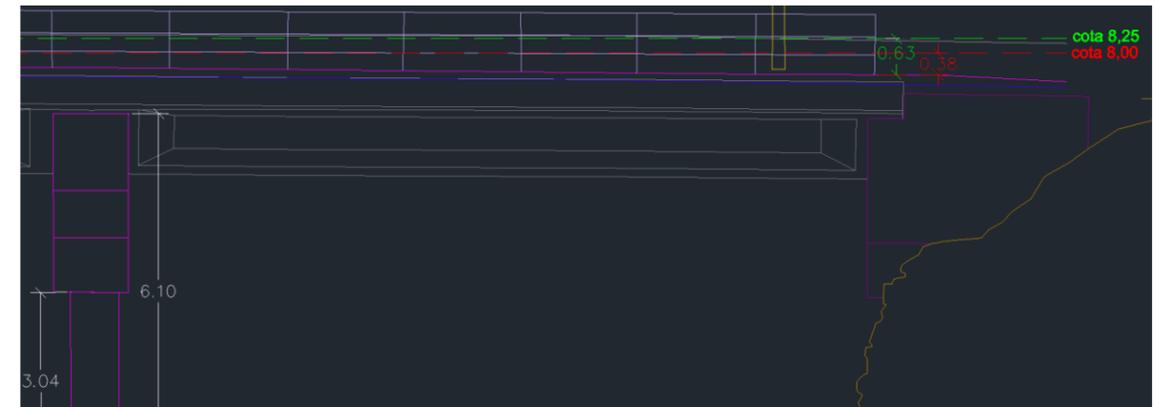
Detalle margen derecha (futura ampliación de vanos). Altura necesaria murete (63 cm) para alcanzar cota 8,25 msnm.
